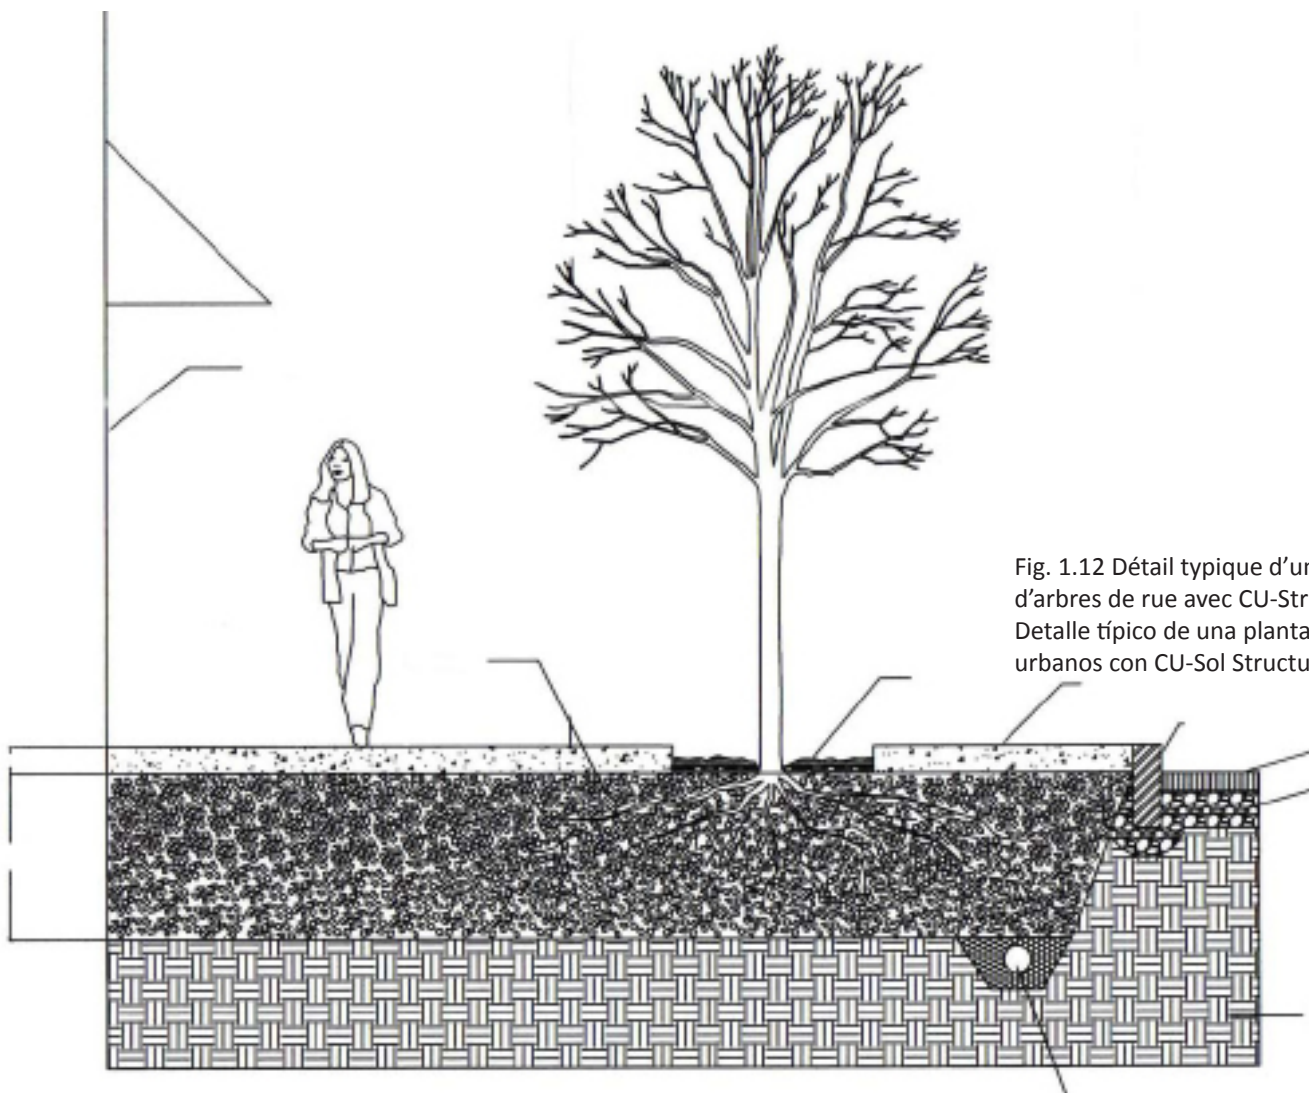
Détail typique d'une plantation d'arbres de rue avec CU-Structural SoilTM / Detalle típico de una plantación de árboles urbanos con CU-Sol Structural<sup>MD</sup>.
